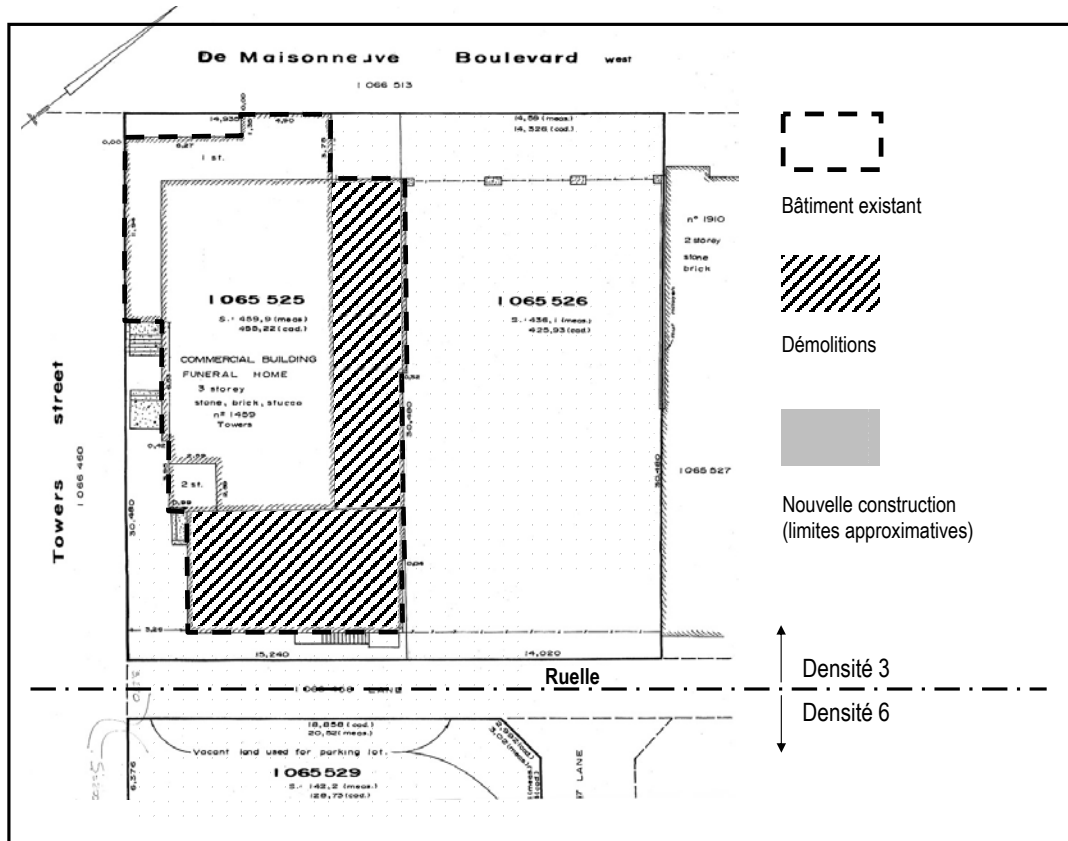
Plan d'implantation du projet d'agrandissement de l'édifice situé au 1455 rue Towers (adapté du document déposé no 5.4, diapositive no 10).
